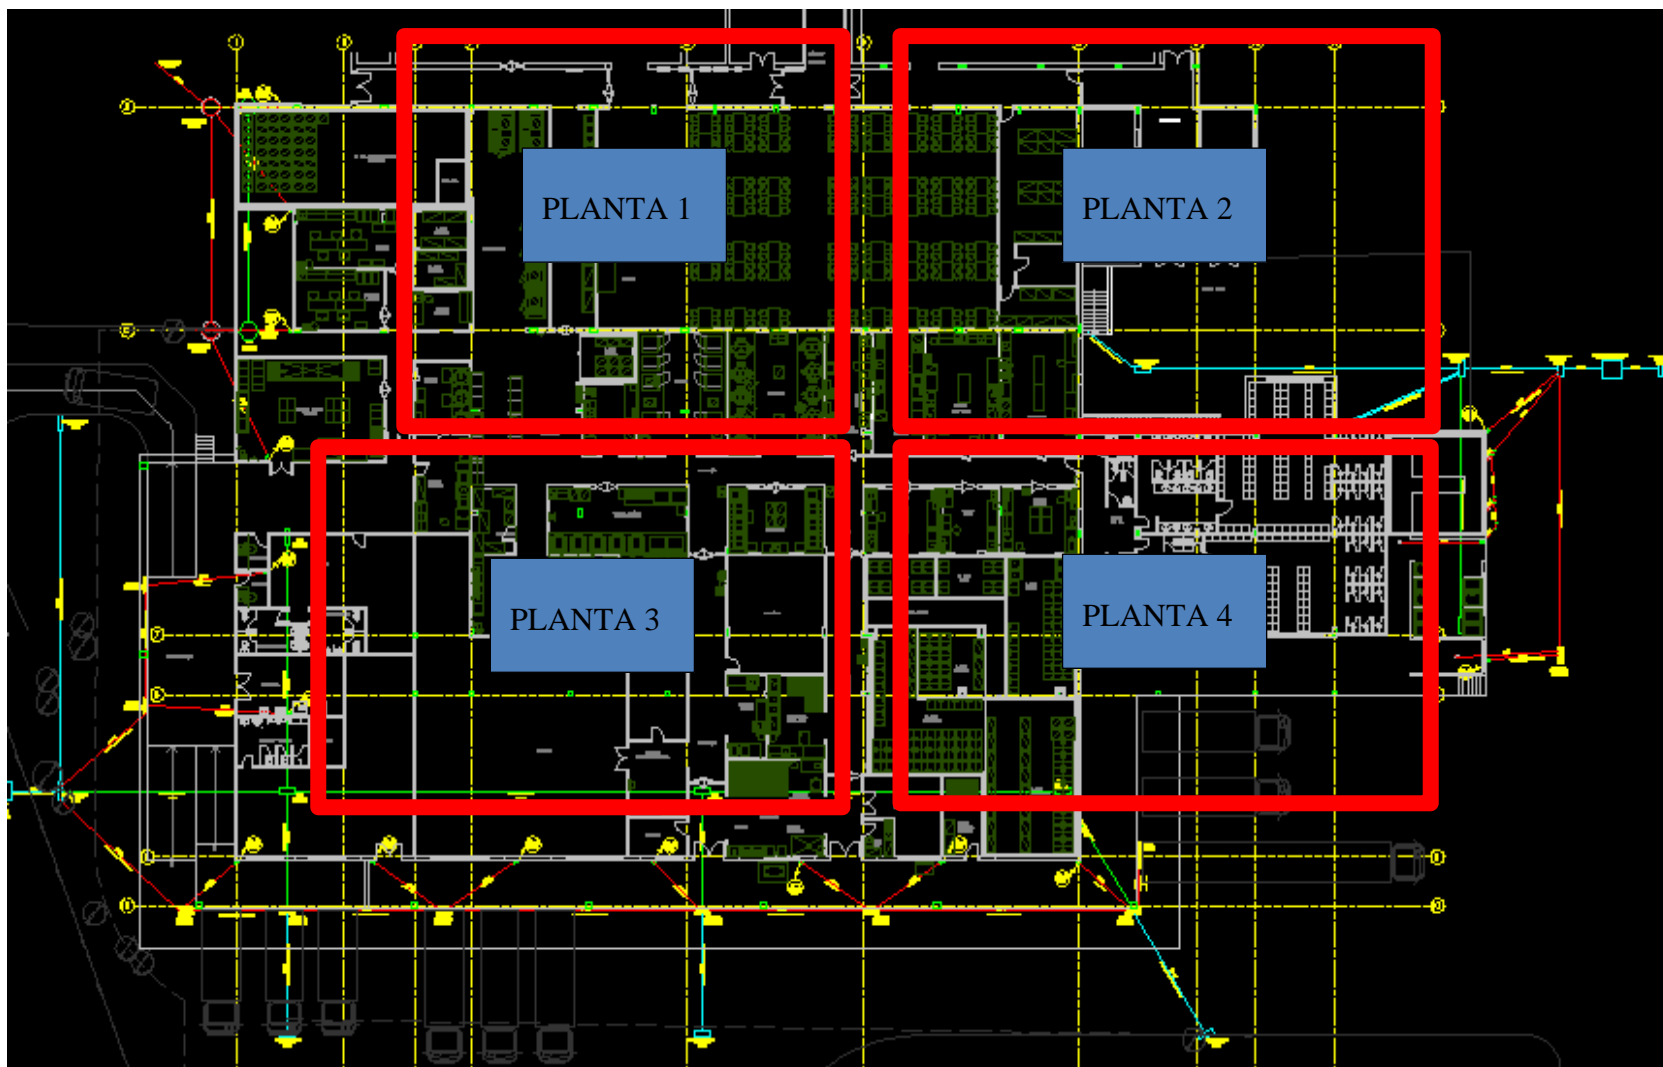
Projeto Hidrossanitário - Planta Baixa 1 a 4 – Restaurante Central da Vale S.A.
